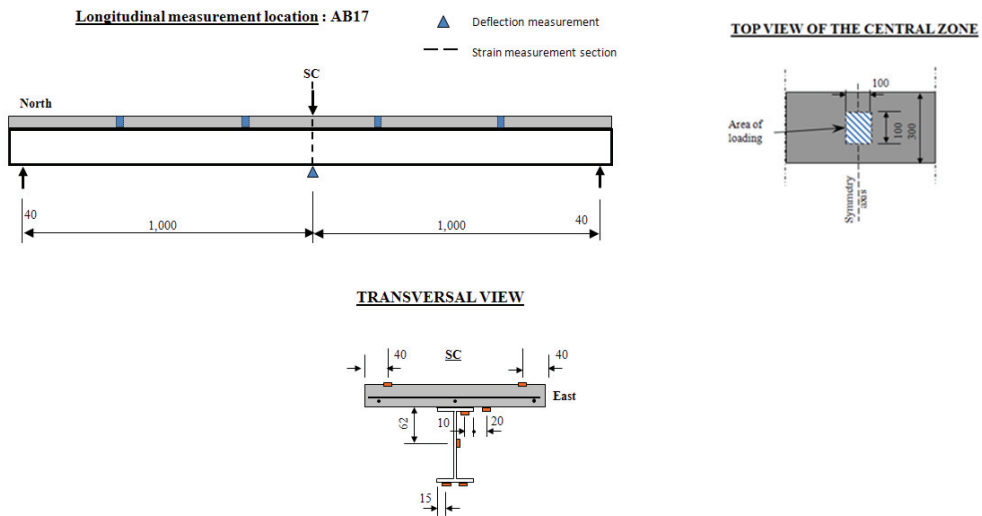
Mesures et chargement de la poutre AB17 après l'essai de fatigue
